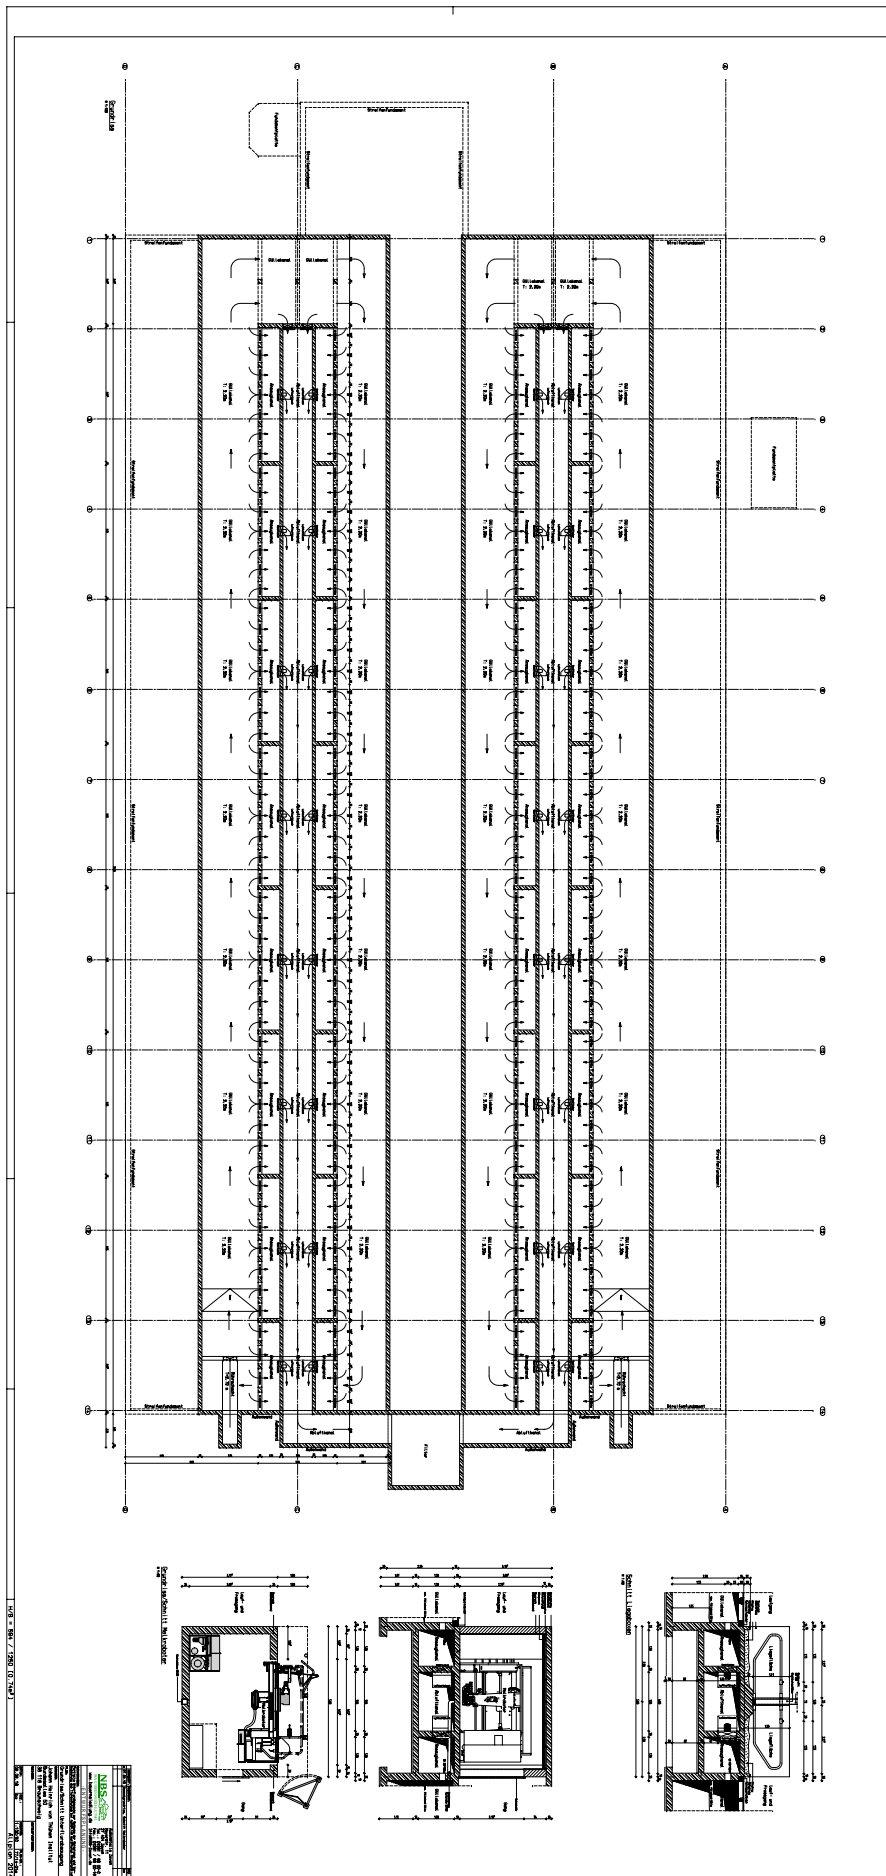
Grundriss und Schnitt Unterflurabsaugung Version 01
